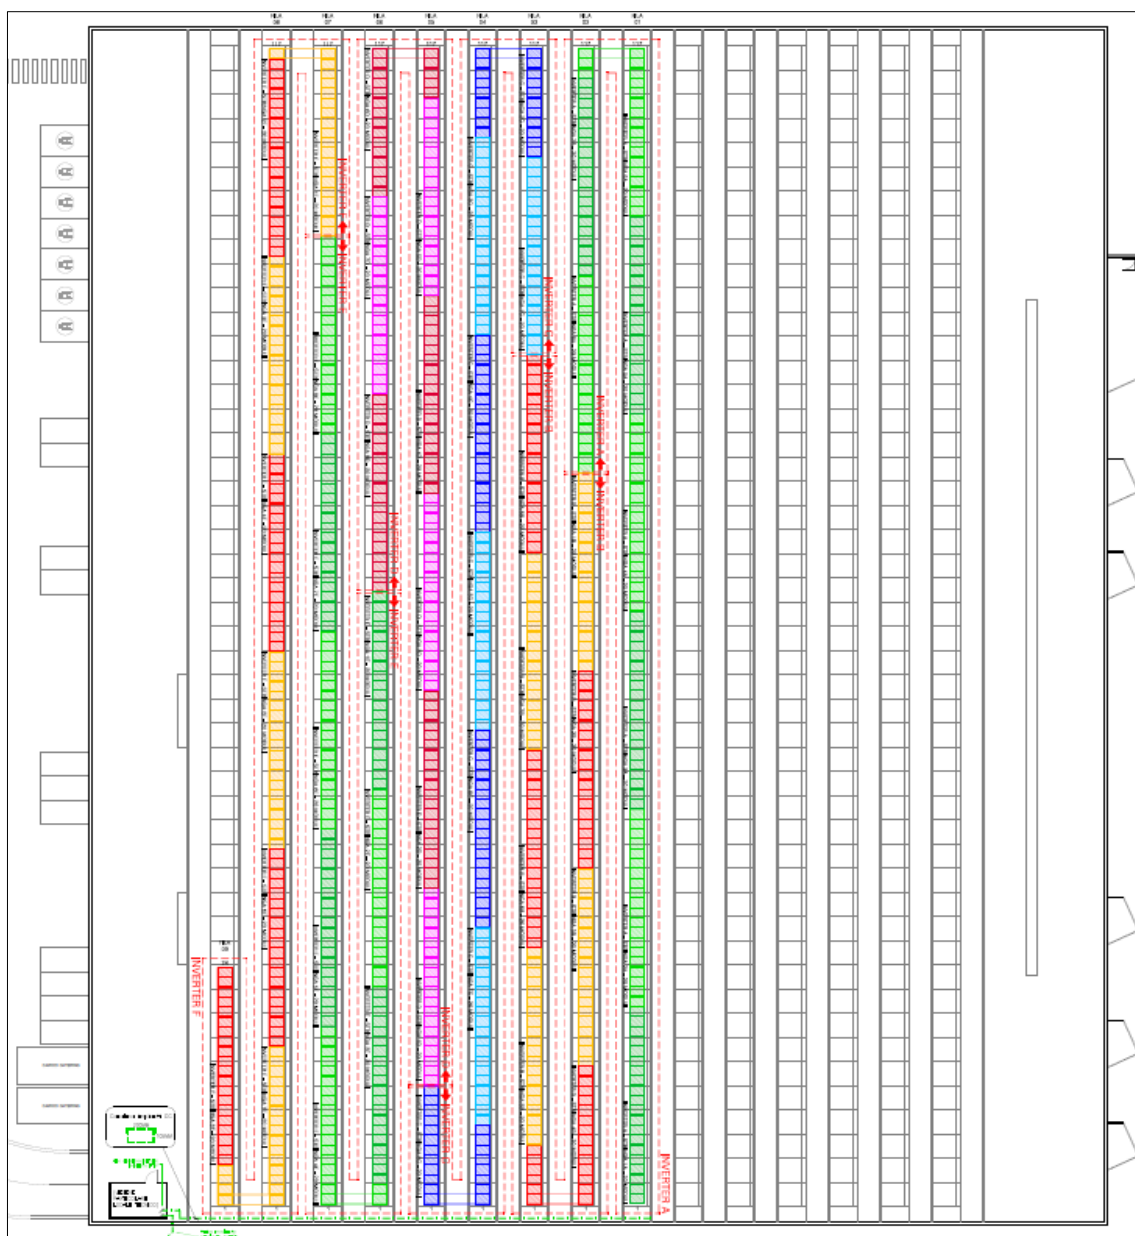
Pianta ubicazione impianto di conversione fotovoltaica
